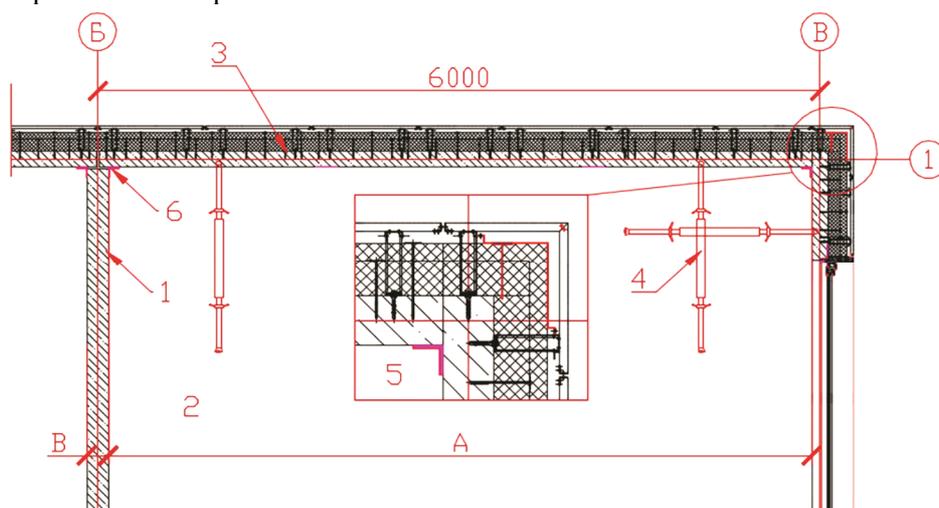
Схема размещения вентфасадных панелей на фрагменте типового этажа панельного дома:
